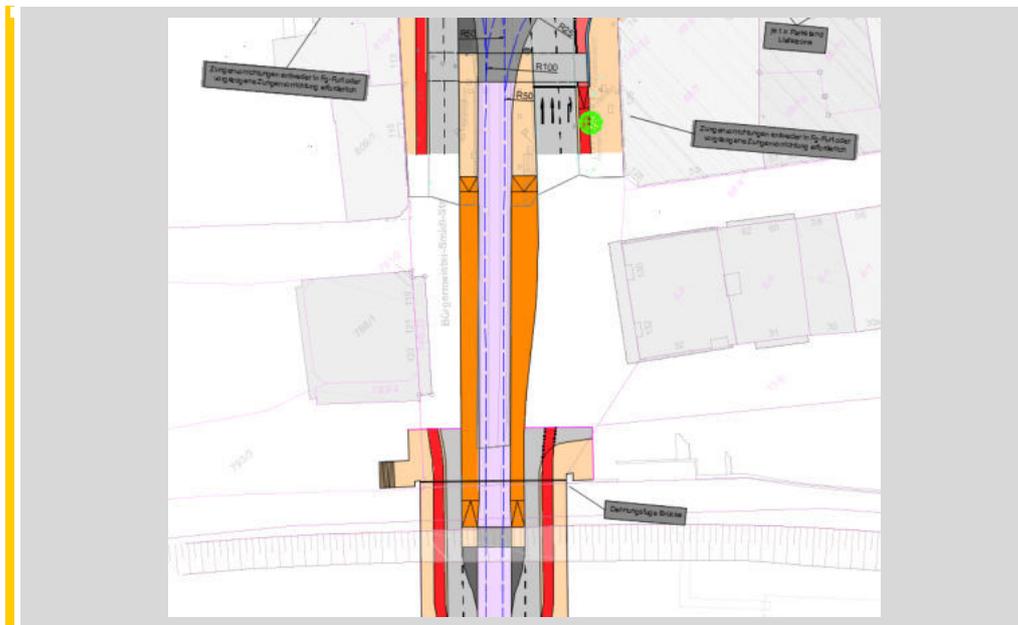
Lageplanausschnitt Haltestelle Am Brill in Bgm.-Smidt-Str.
